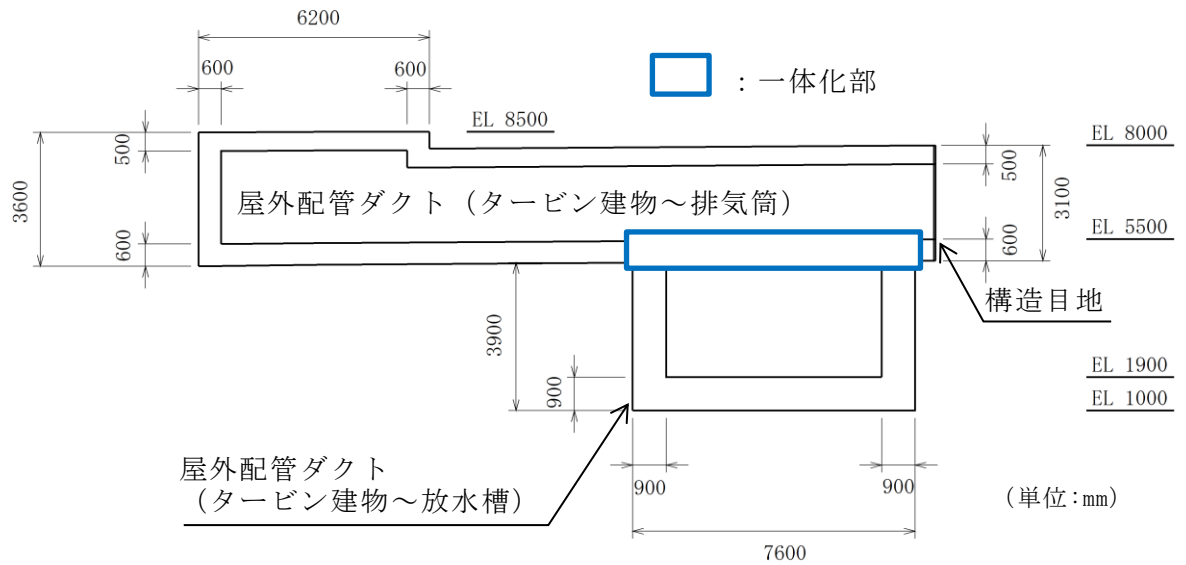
屋外配管ダクト (タービン建物～排気筒) 断面図 (C-C 断面)
